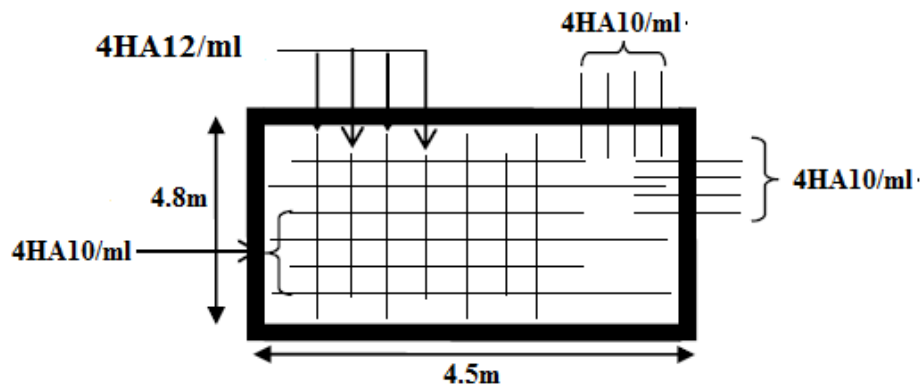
Schéma de ferrailage de la dalle pleine sur quatre appuis
